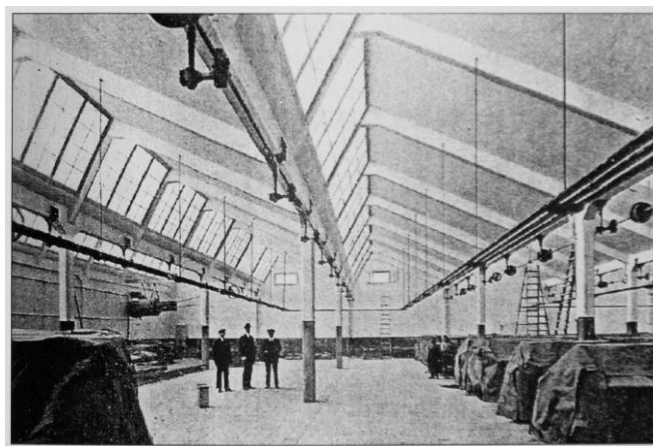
Cubierta inclinada de hormigón armado de la fábrica de tejidos de Cardedeu. Construcciones y Pavimentos 1910-1920.
